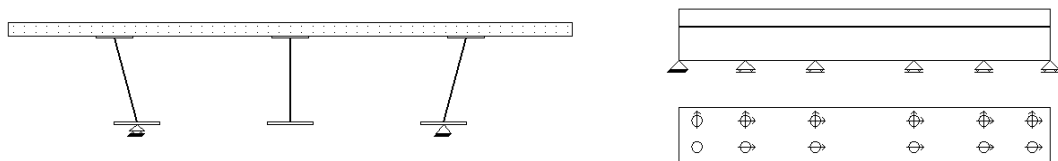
Sezione trasversale dell'impalcato e disposizione dei vincoli.
